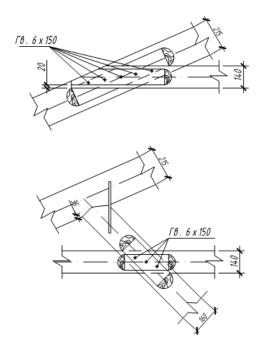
Узлы соединения ригеля со стропильной ногой и подкосом
